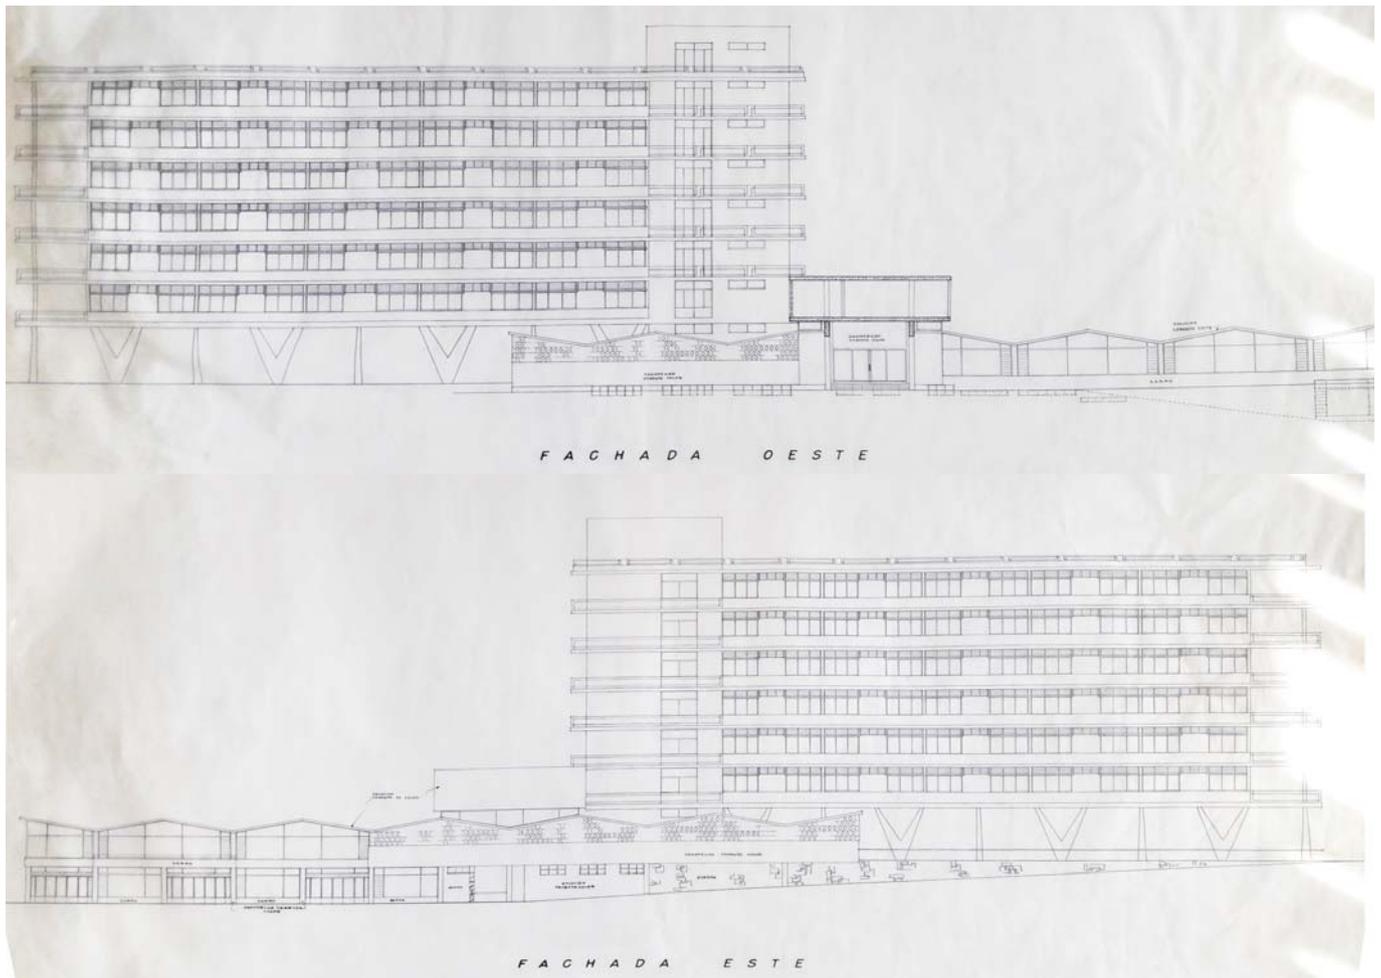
Fotografía de fachadas este y oeste del volúmen que no se construyó
